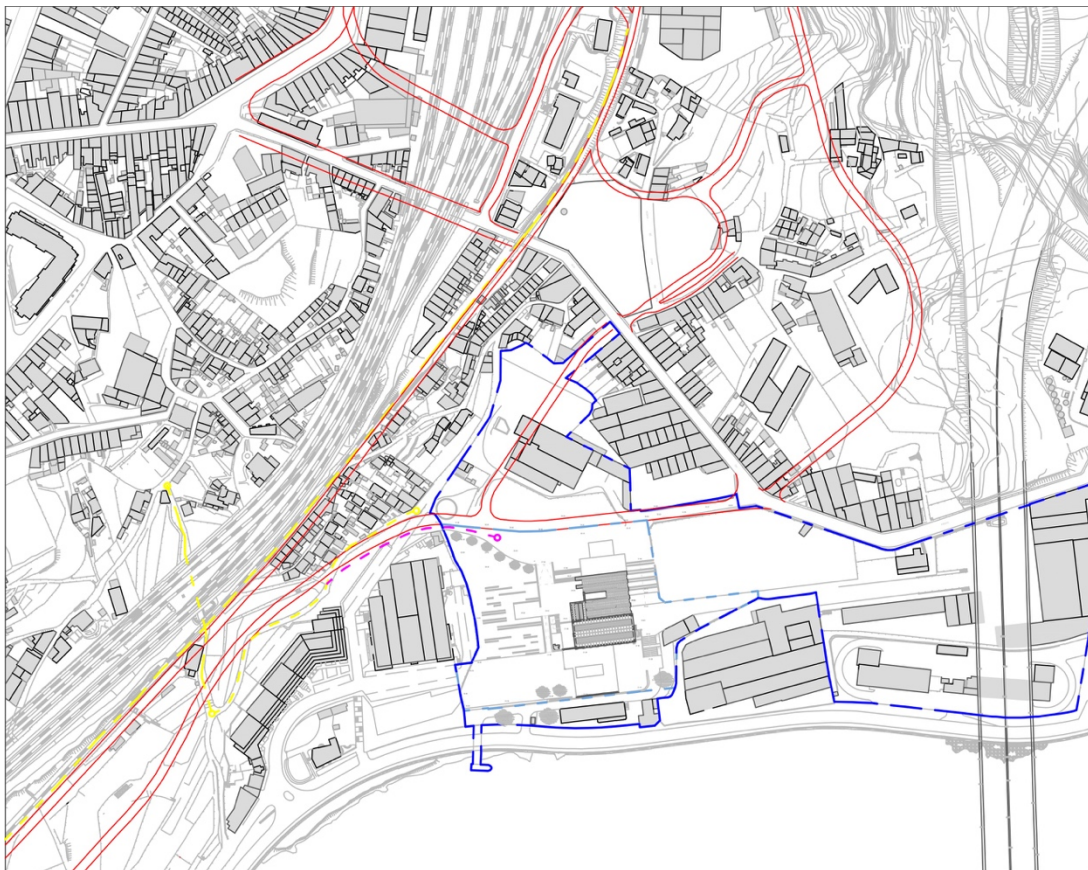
Planta de localização com sobreposição da planta síntese das estratégias territorial da unidade sul – ARU Campanhã – Estação;
